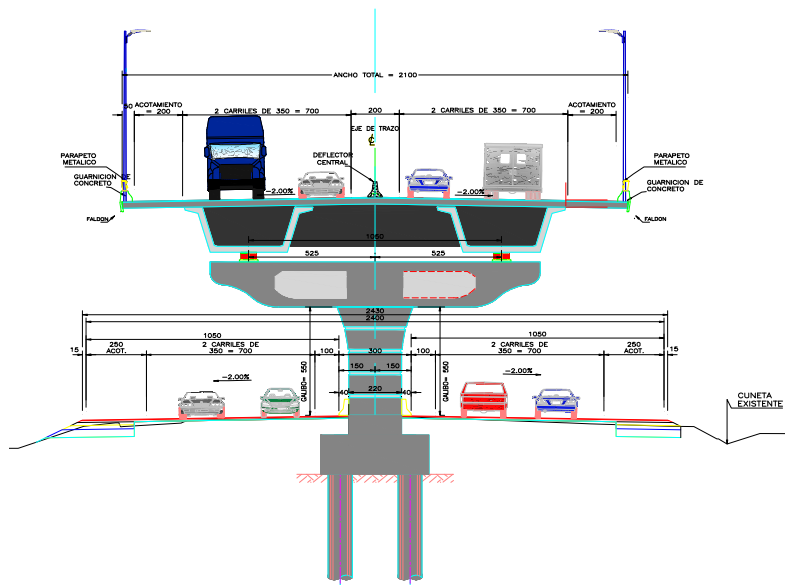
Sección transversal de la autopista en etapa final. (Fuente: plano de planta general de proyecto)
